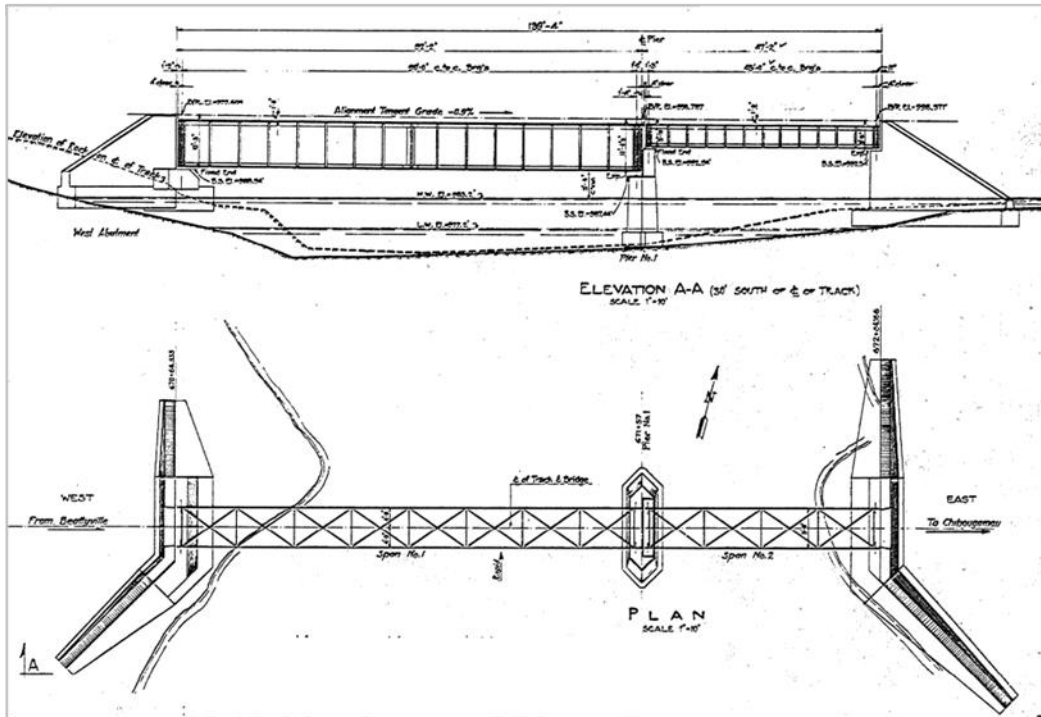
Vue en plan et en élévation du pont PM 122.30 Chapais
